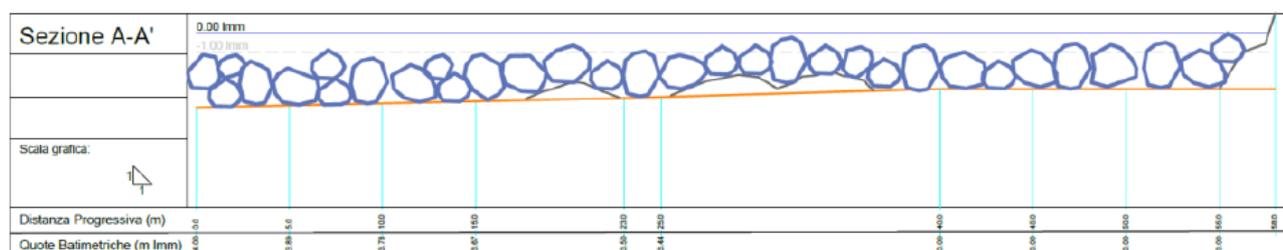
Sezione tipo del progetto in scala 1:200 (fonte Relazione generale del progetto)
